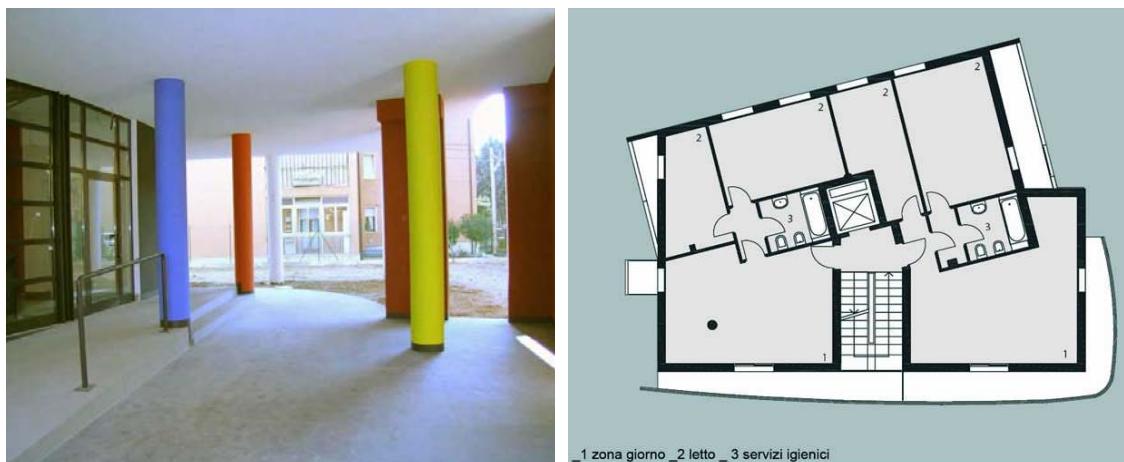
Casa per lavoratori immigrati M. Pettoello, Verona, fotografia p.t e pianta piano tipo
